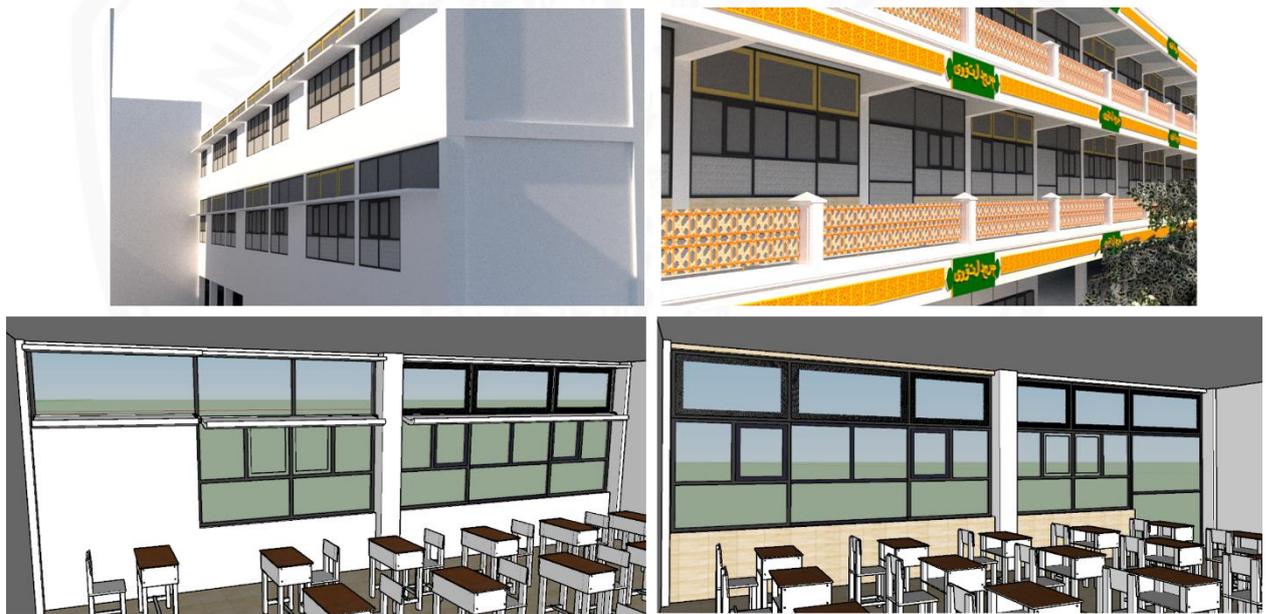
64 Ruang kelas SD lantai 2 rekomendasi terbaik
